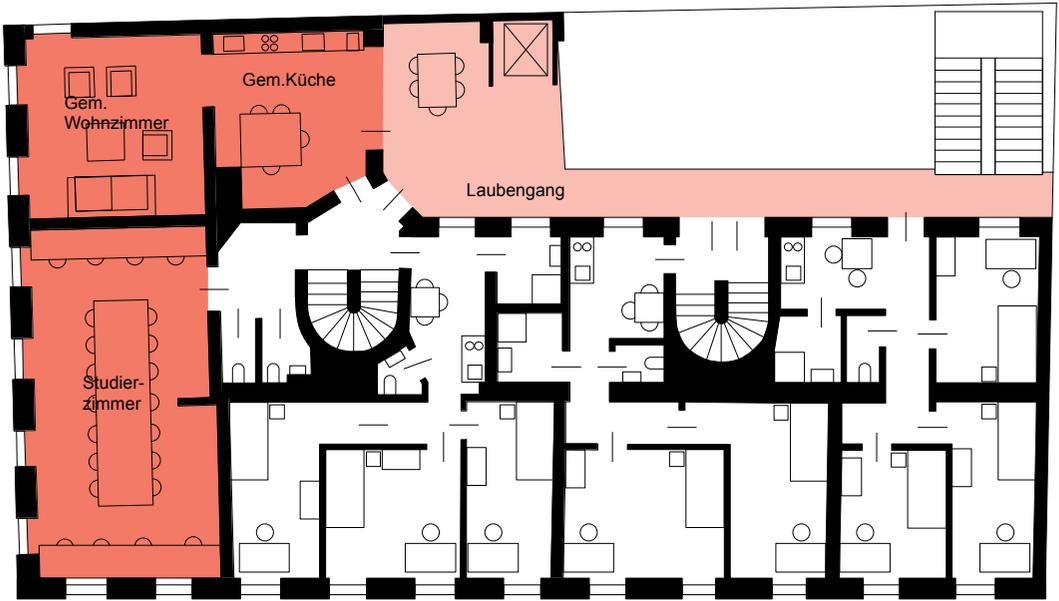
VinziRast, Grundriss 2.OG
